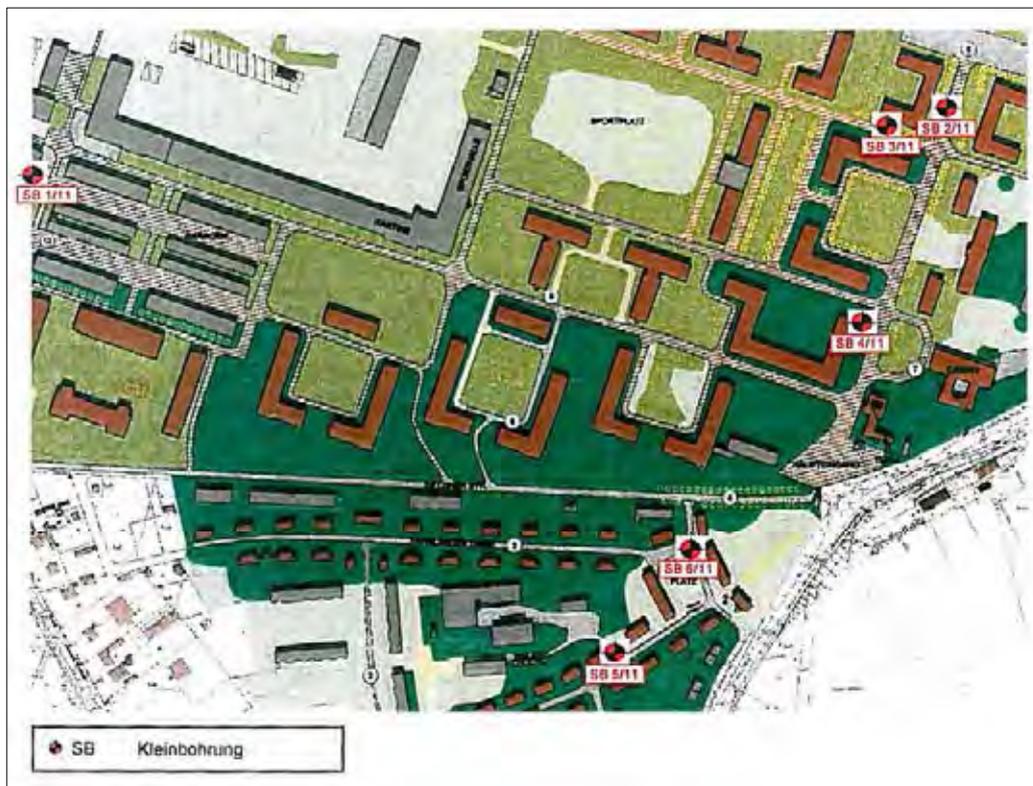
Lage der Bohrpunkte/ Aufschlussprofile
